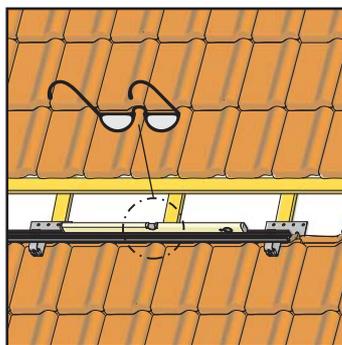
Orientare i profilati parallelamente al bordo delle tegole
